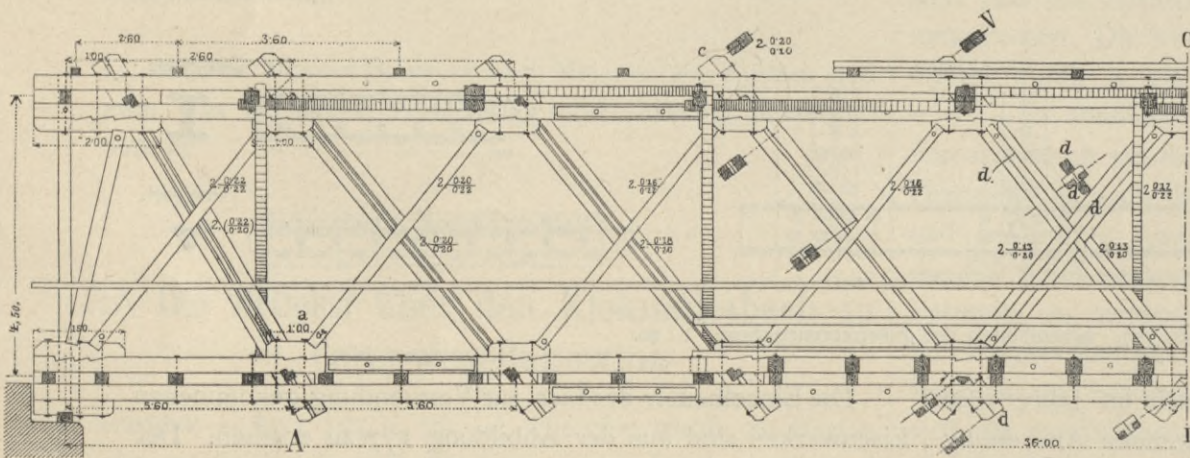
Gitterbrücke System Ibjanski. Ansicht und Längenschnitt. 1 : 125.
